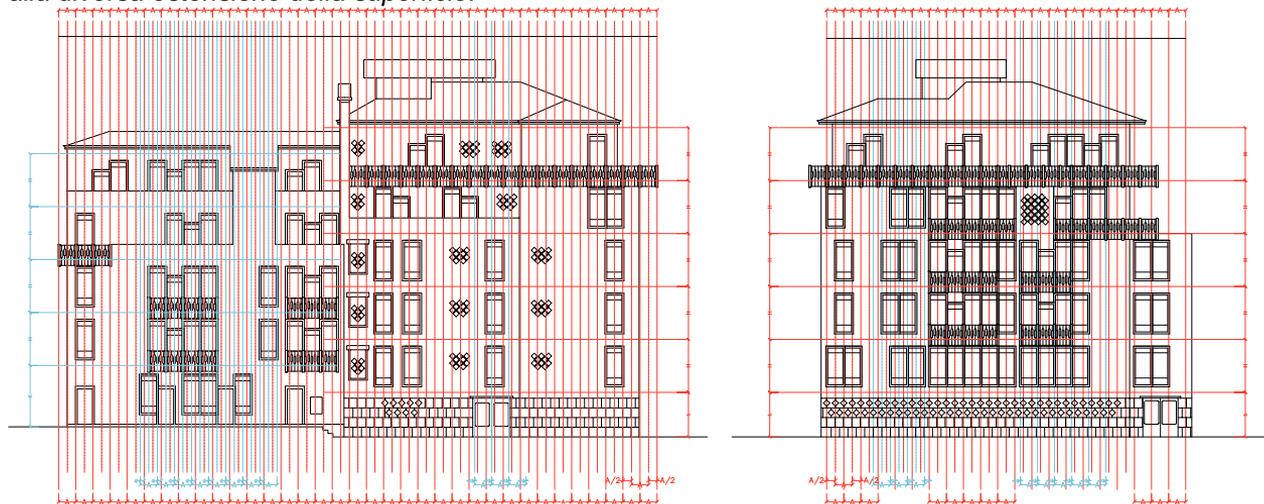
Casa alle Zattere, prospetti su Fondamenta delle Zattere e su Calle dello Zucchero con individuazione del sistema proporzionale.
